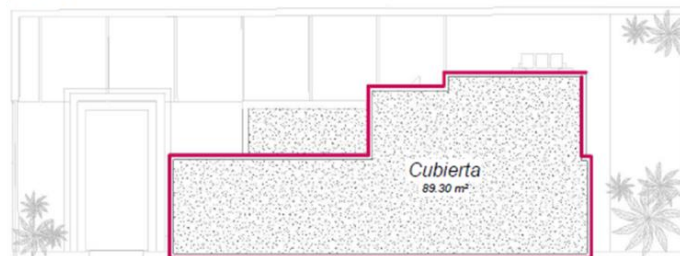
Planos de edificabilidad, Santa Clara 30
